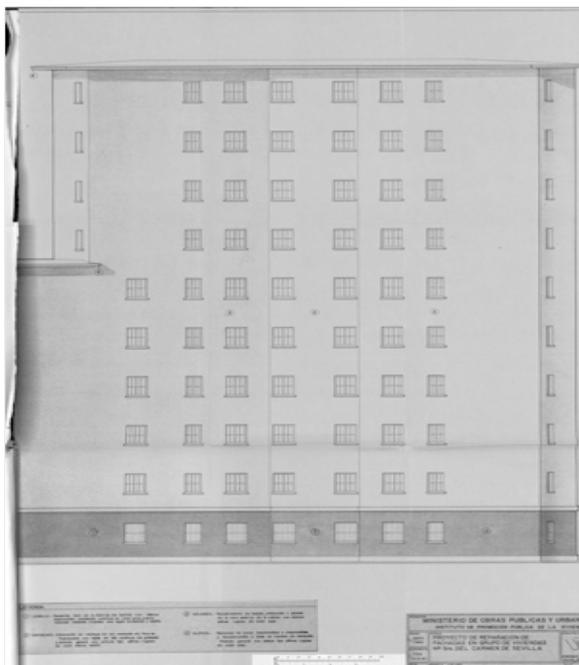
Fachada de uno de los bloques altos. Alzado lateral. Fuente: Expediente 735. Hoja 4 - 3. Mayo, 1983. ICAS - SAHP.
